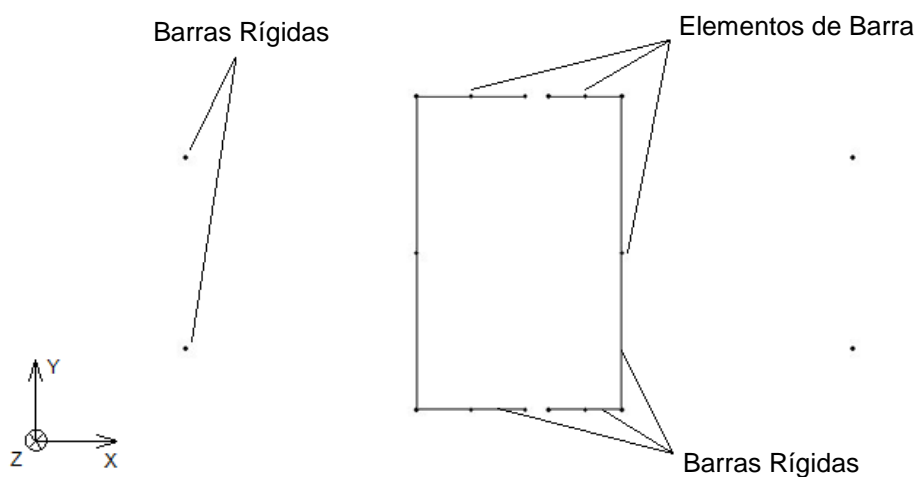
Vista em planta, a partir do 37º piso, do núcleo central com aberturas e dos pilares laterais
